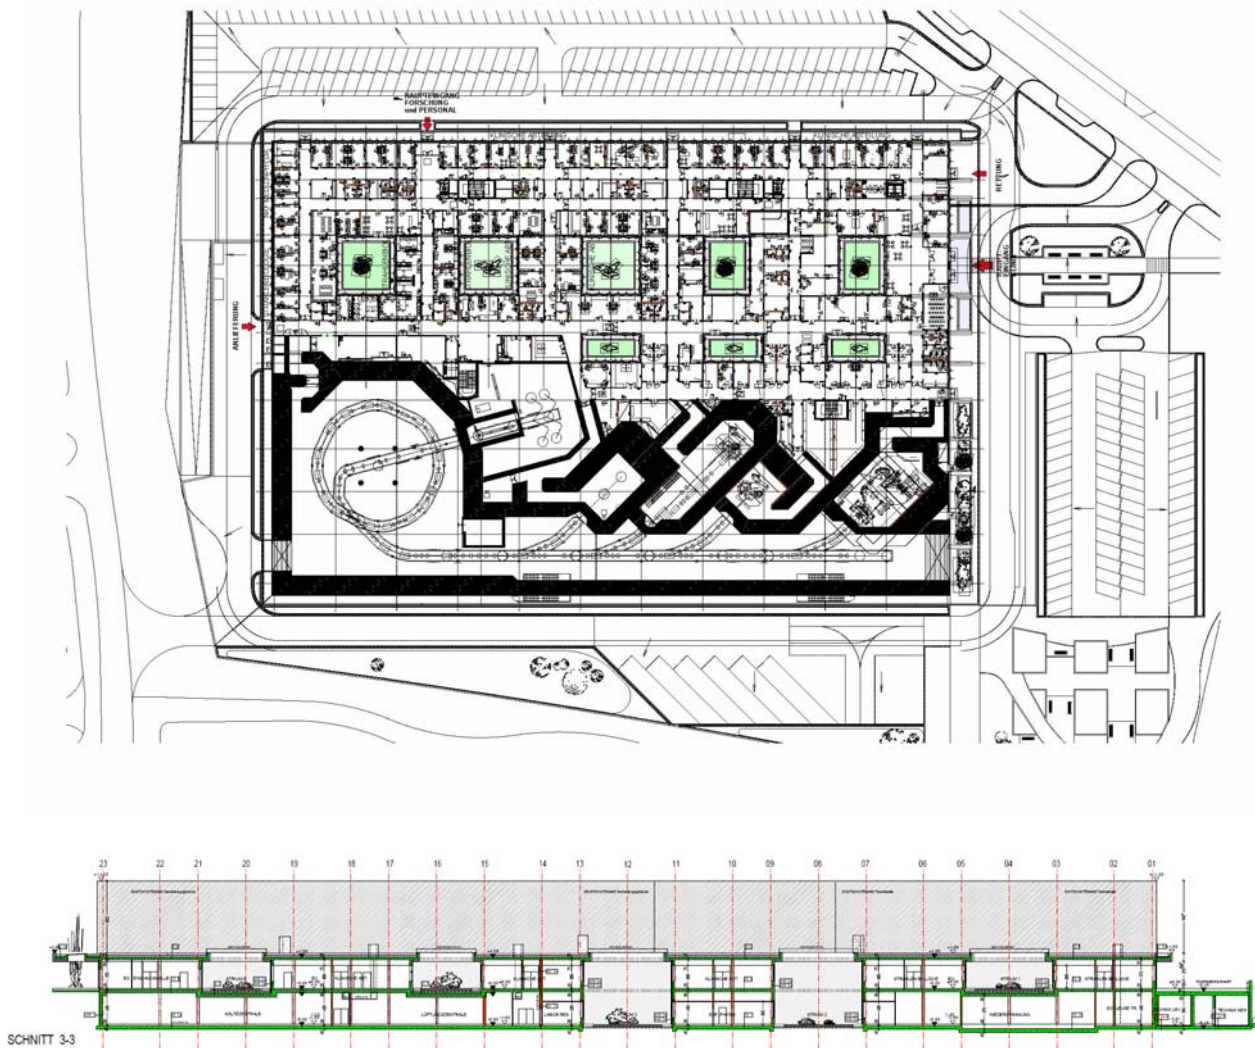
Architektonisches Konzept mit Lichthöfen und Atrien in Grundriss (oben) und Schnitt (unten)
